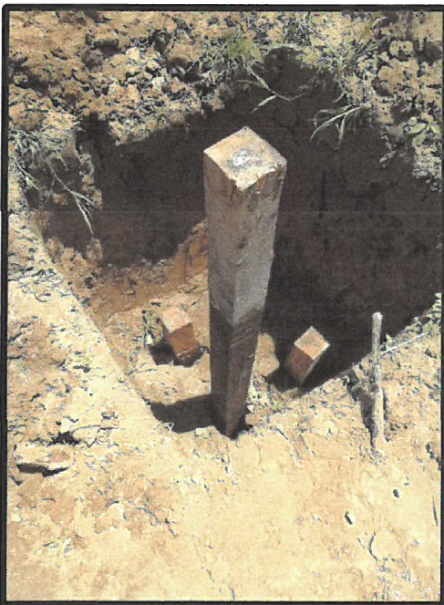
PILOTES DE MADERA DE 5 M HINCADO QUE PRESENTO RECHAZO A LOS 2.8 M DE PROFUNDIDAD
